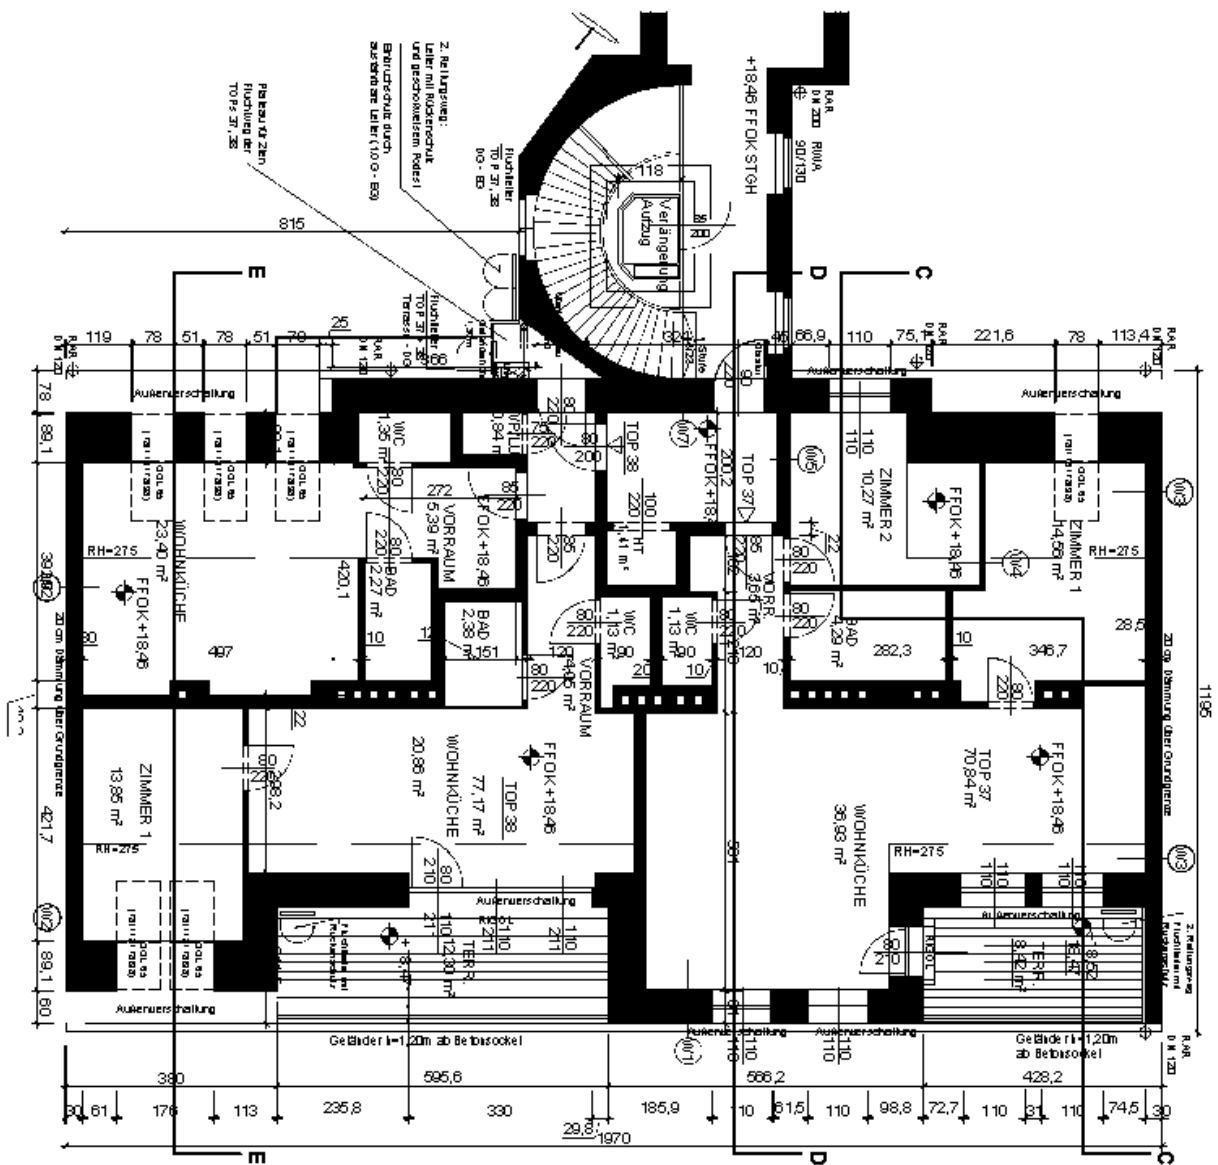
Grundriss des Dachgeschosses – Hoftrakt
